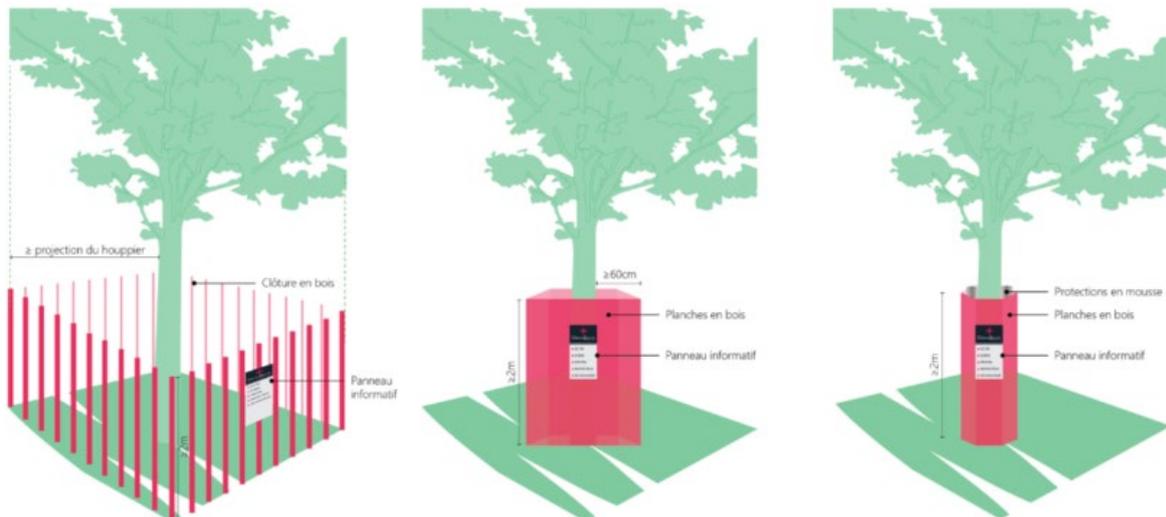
Exemple de dispositifs de protection des arbres de gauche à droite : protection en bois – enceinte en bois – enceinte en bois et protection en mousse (Source : Notice paysagère)
